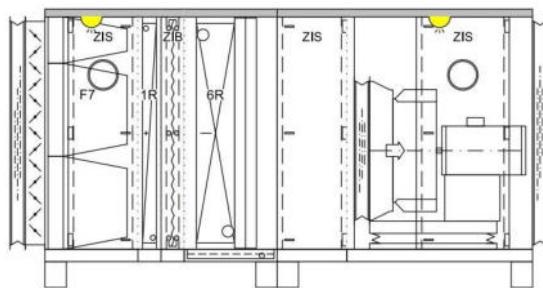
Чертеж агрегата без регулировки опор по высоте
